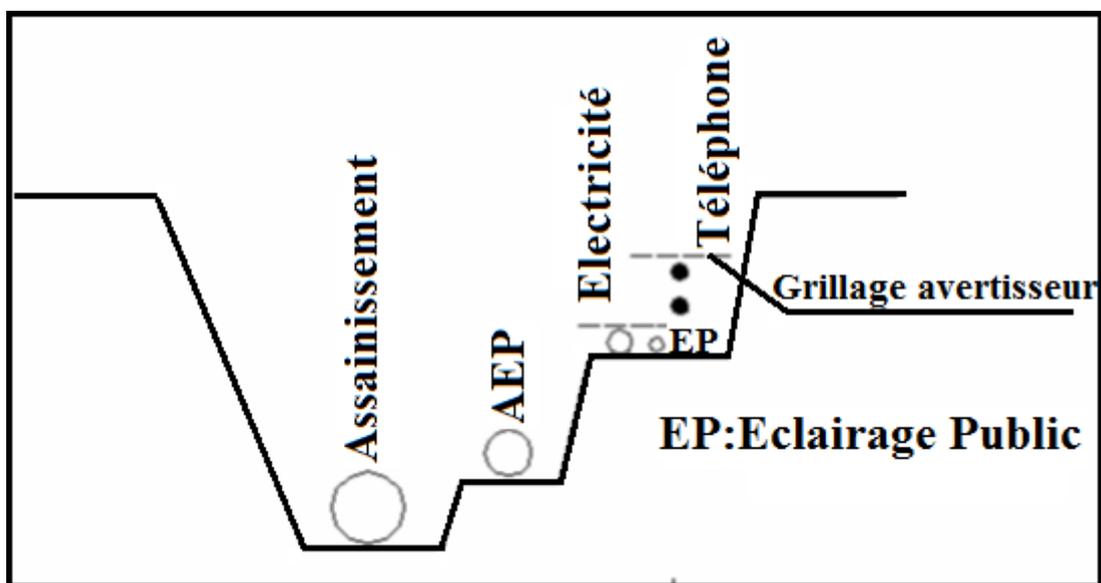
Implantation du réseau d'assainissement par rapport aux autres réseaux
